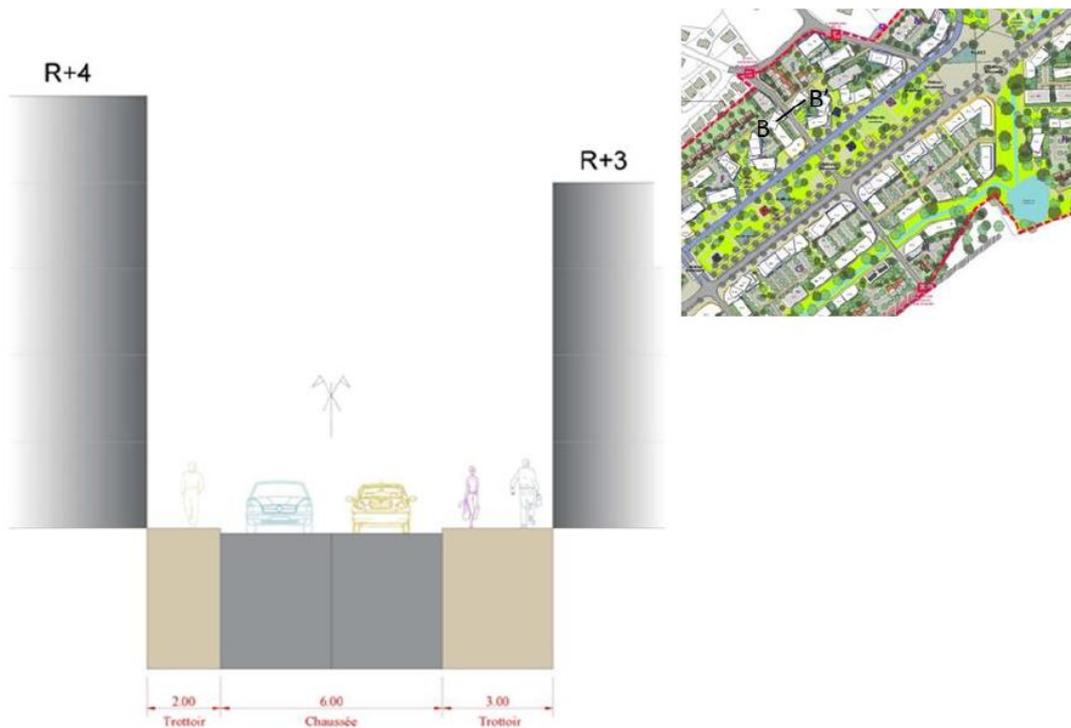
COUPE DE PRINCIPE DES VOIES STRUCTURANTES SECONDAIRES – SOURCE : TPFI 2017
